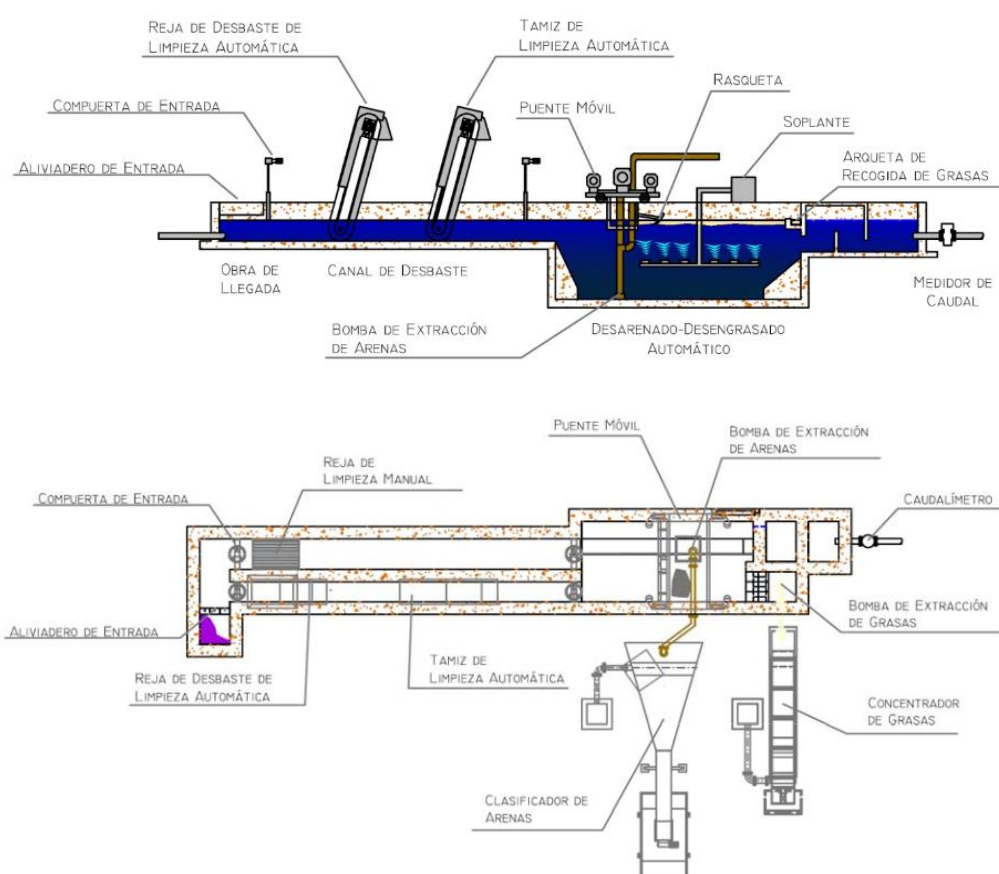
Planta y perfil de la etapa de pretratamiento con elementos de limpieza automática. Fuente: Ministerio de Fomento
